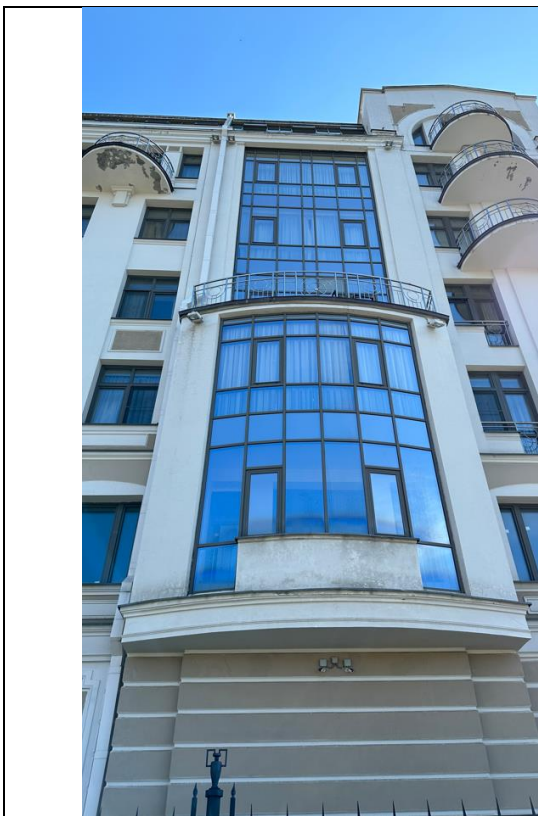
Общий вид условной части №3 западной стороны фасада здания и дефекты в виде растрескивания штукатурки и окраски на фасаде, откосах и балконах
